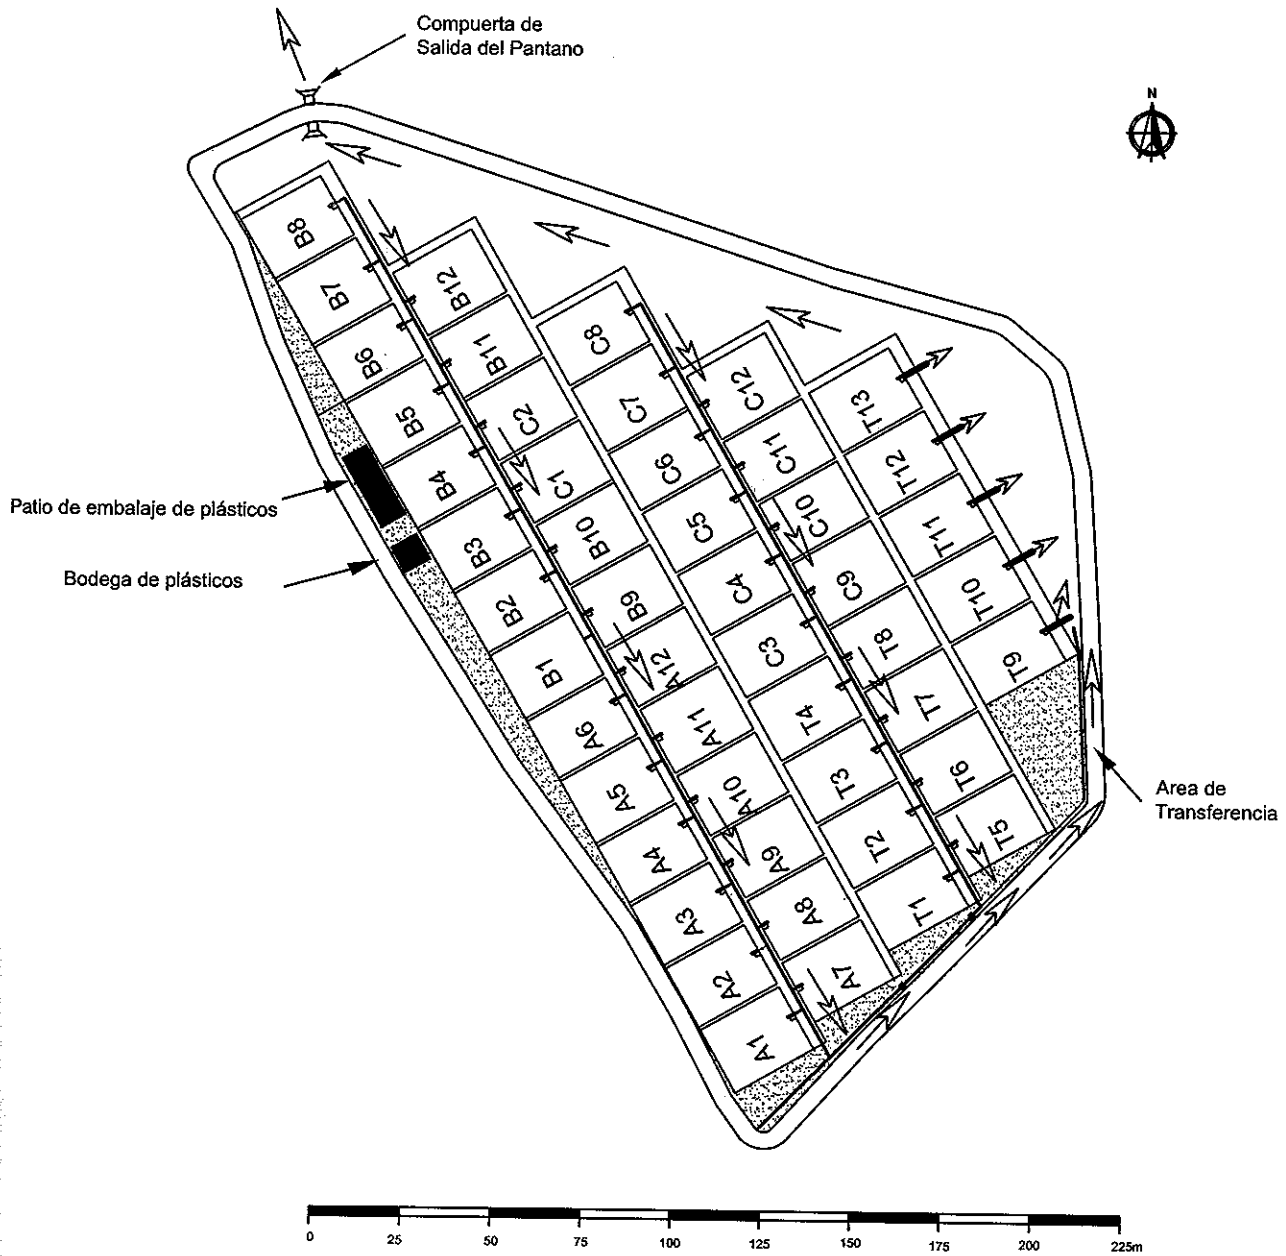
Plan del sistema de drenaje para el Sector A de la estación experimental del CENAIM.
